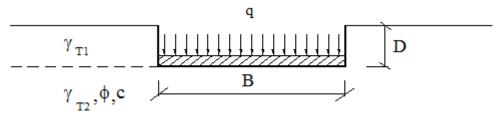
individuazione parametri per il calcolo di Q<sub>lim</sub>
